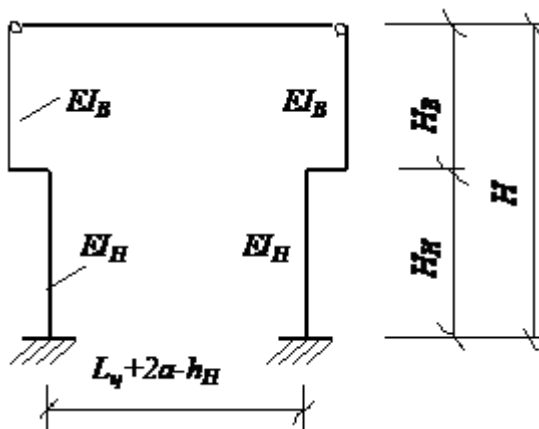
Статична розрахункова схема рами промислових будівель.
